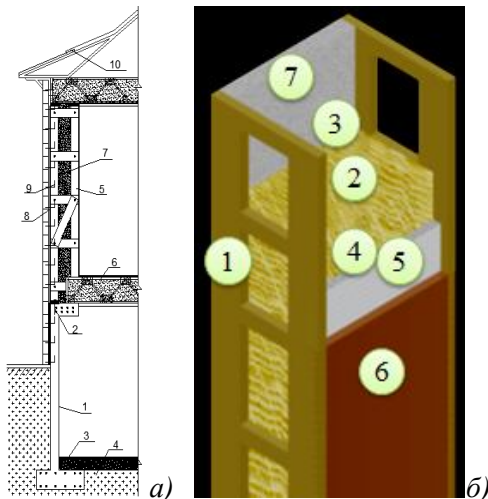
Конструкция малоэтажного здания / Construction of low-storey building:
